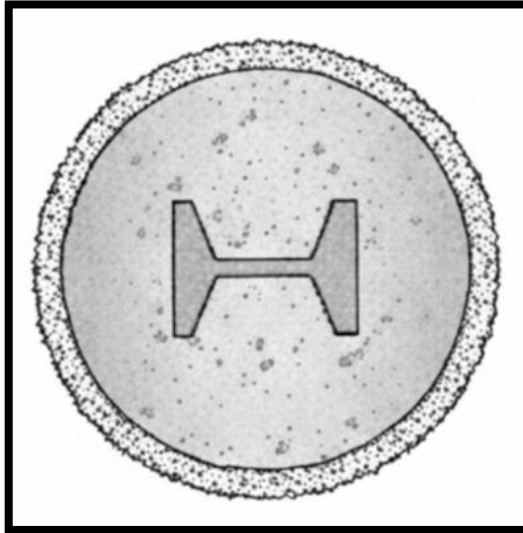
Vista de Cima do Poste e do Solo-Cimento ao Redor
